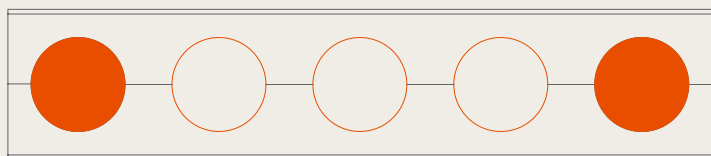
Exemple de poutre ACB® avec alvéoles obturées
